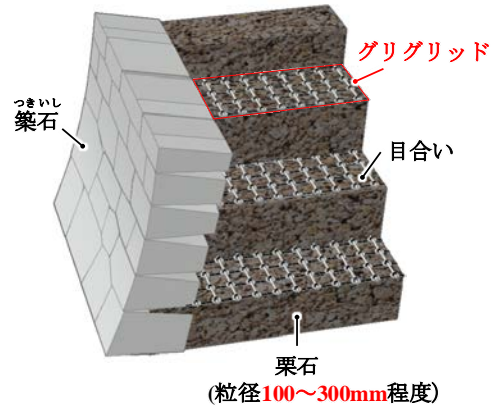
グリッドによる城郭石垣の補強 Reinforcement of Castle Wall by “Guri-Grid”
